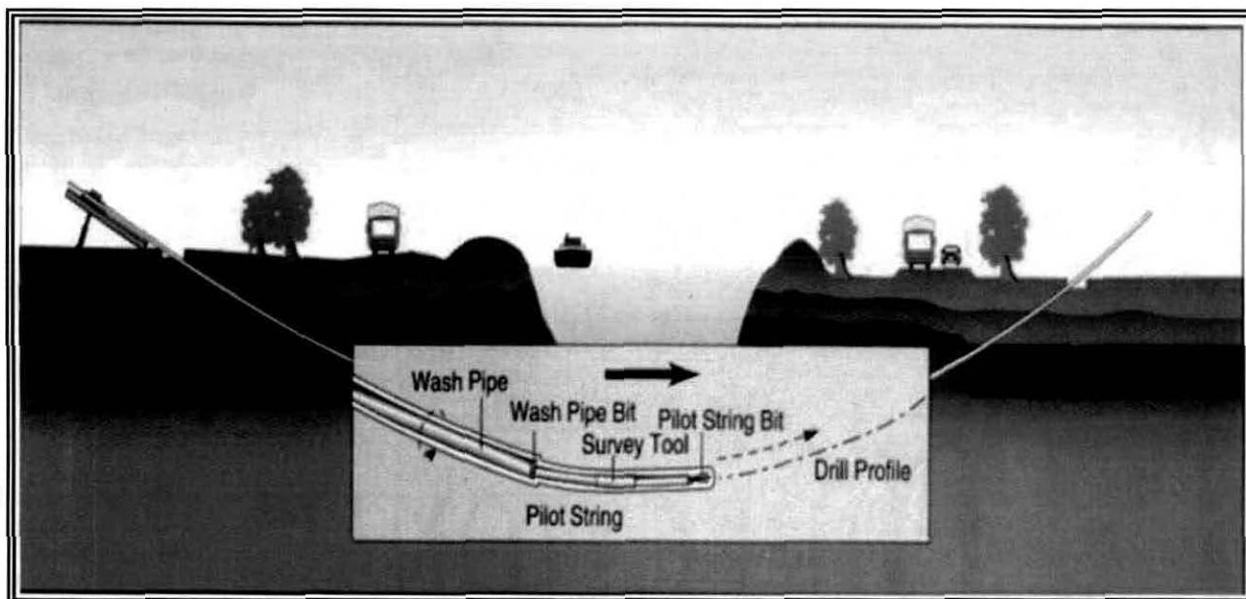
Técnica de perforación direccional empleada para colocar las tuberías de manera horizontal.
